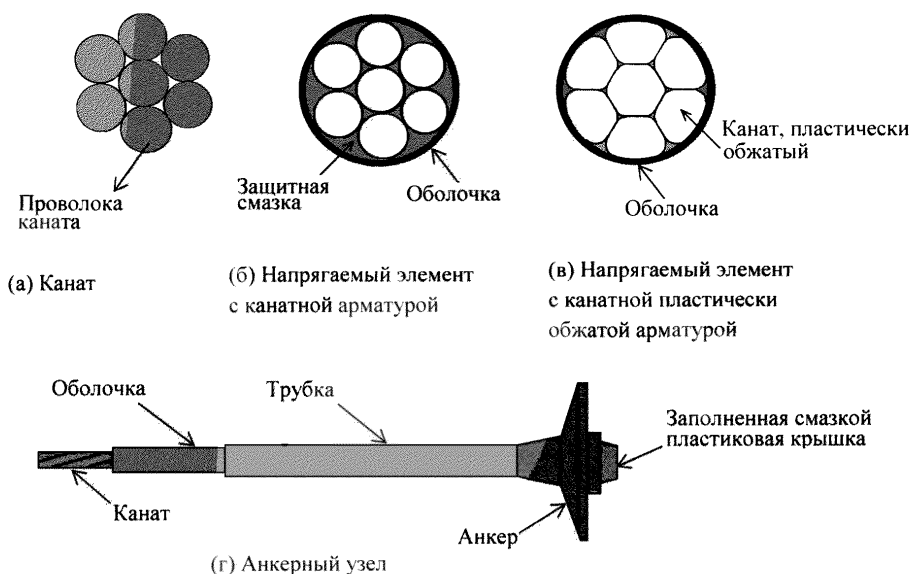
Принципиальная конструкция арматурных напрягаемых элементов и анкеров для систем без сцепления арматуры с бетоном
